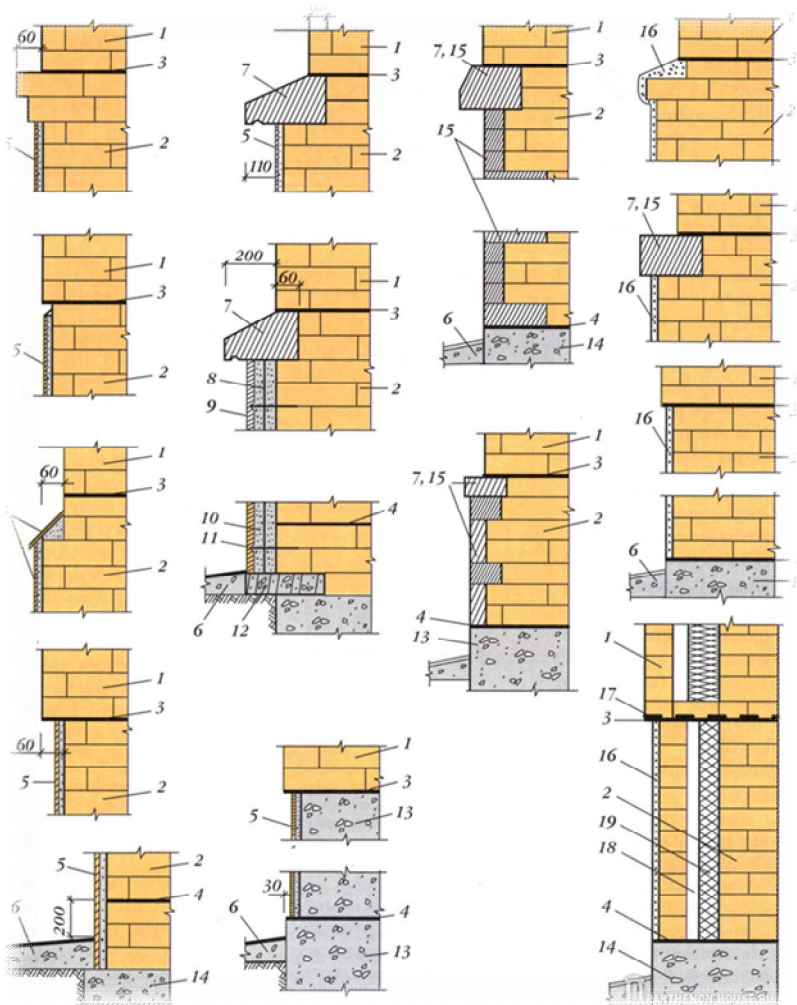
Цоколі: 1 – конструкція стіни; 2 – цоколь із цегли; 3 – гідроізоляція з двох шарів толю або підкладкового руберойду; 4 – друга гідроізоляція по фундаменту або в тілі цоколя; 5 – керамічна плитка на цементно-піщаному розчині; 6 – вимощення; 7 – облицювальний фризний камінь; 8 – сітка 150 см × 150 см × 4 см, прив'язана до випусків арматури; 9 – облицювальна плитка з природного каменю; 10 – жорсткий цементний розчин; 11 – випуски арматури, закладені в кладку; 12 – бетонна подушка; 13 – фундаментні бетонні блоки; 14 – фундамент (зі збірних блоків, бутової кладки, буту тощо); 15 – облицювальна цегла, 16 – штукатурка; 17 – арматурна сітка; 18 – повітряний продух; 19 – утеплювач
